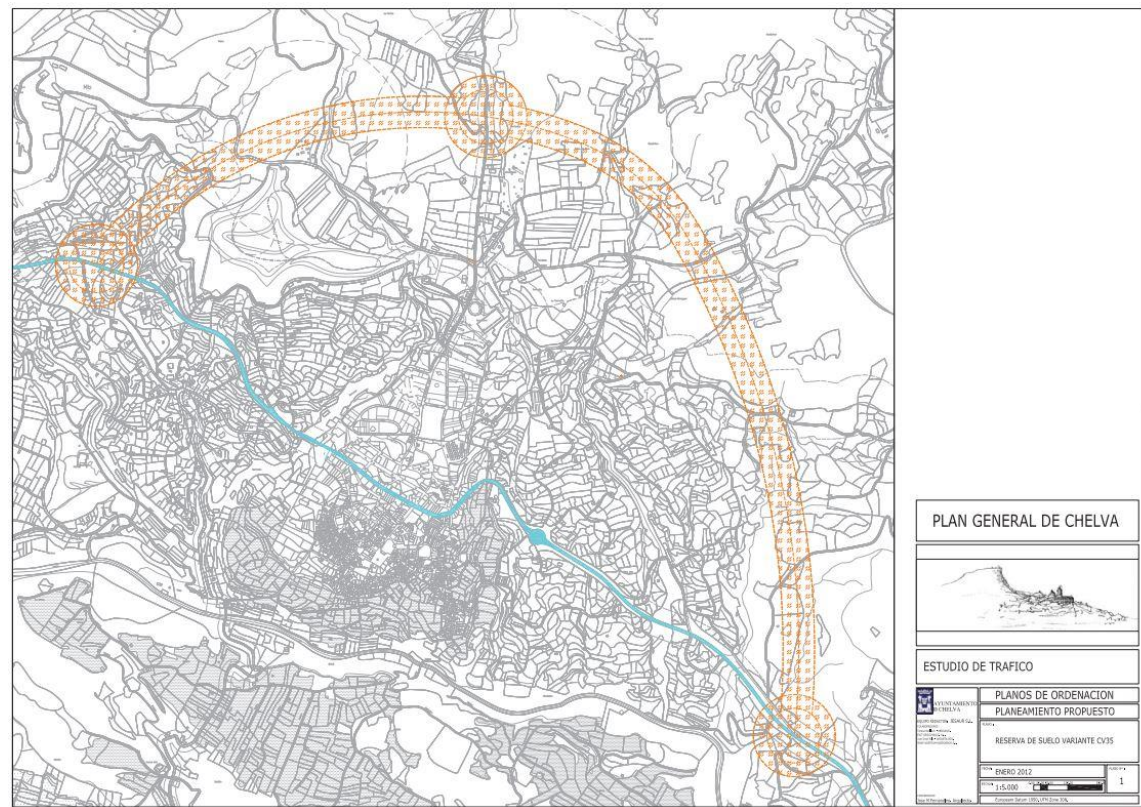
Planeamiento propuesto en el plan general de Chelva.
